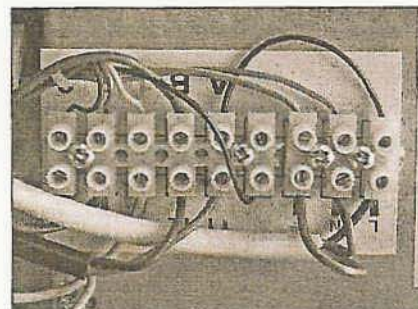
Sluit de aansluitkabel aan op T1 en T2.
